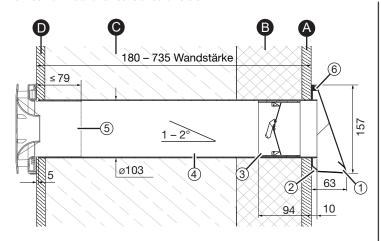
Sectional drawing aV100 wall installation set Standard version with Avio N 100
